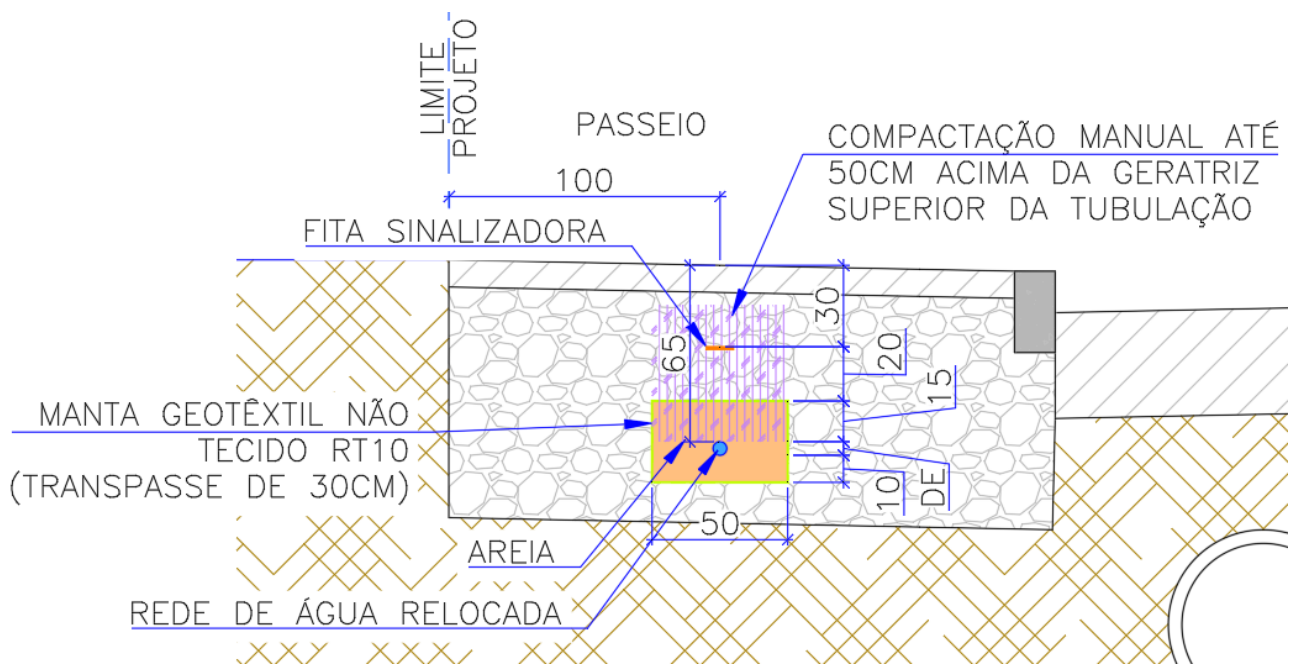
Detalhe Envoltória Da Tubulação Abaixo Do Pavimento
